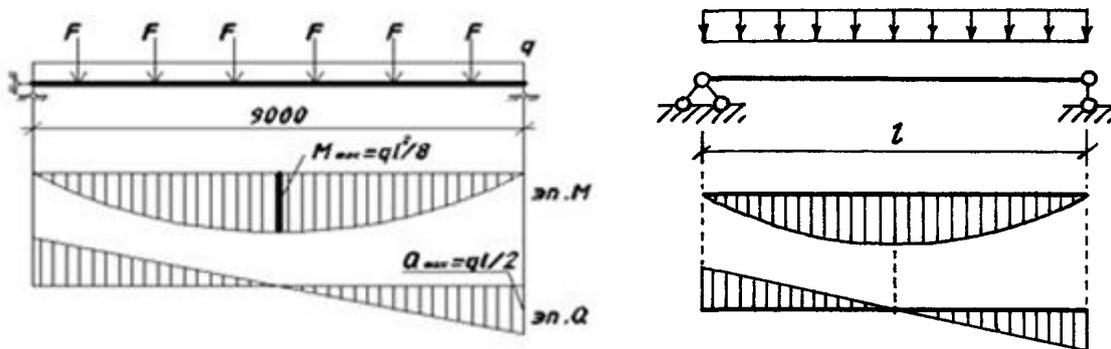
Расчетная схема двутавровой клееной деревянной балки
